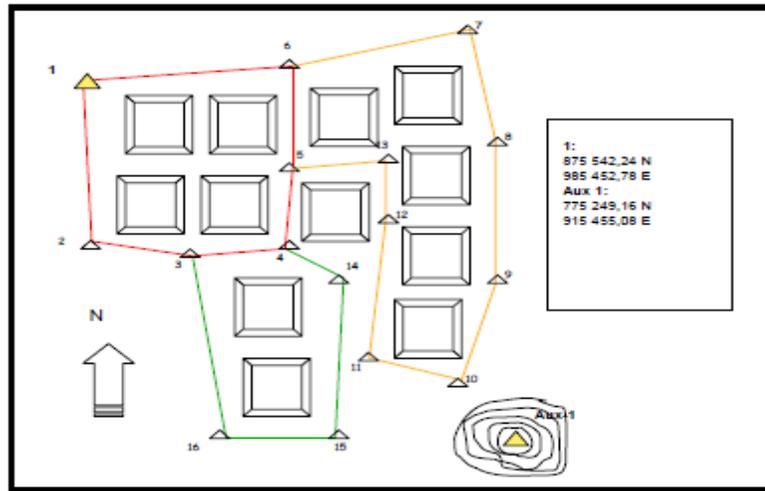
Levantamiento de un grupo de manzanas con poligonal cerrada
